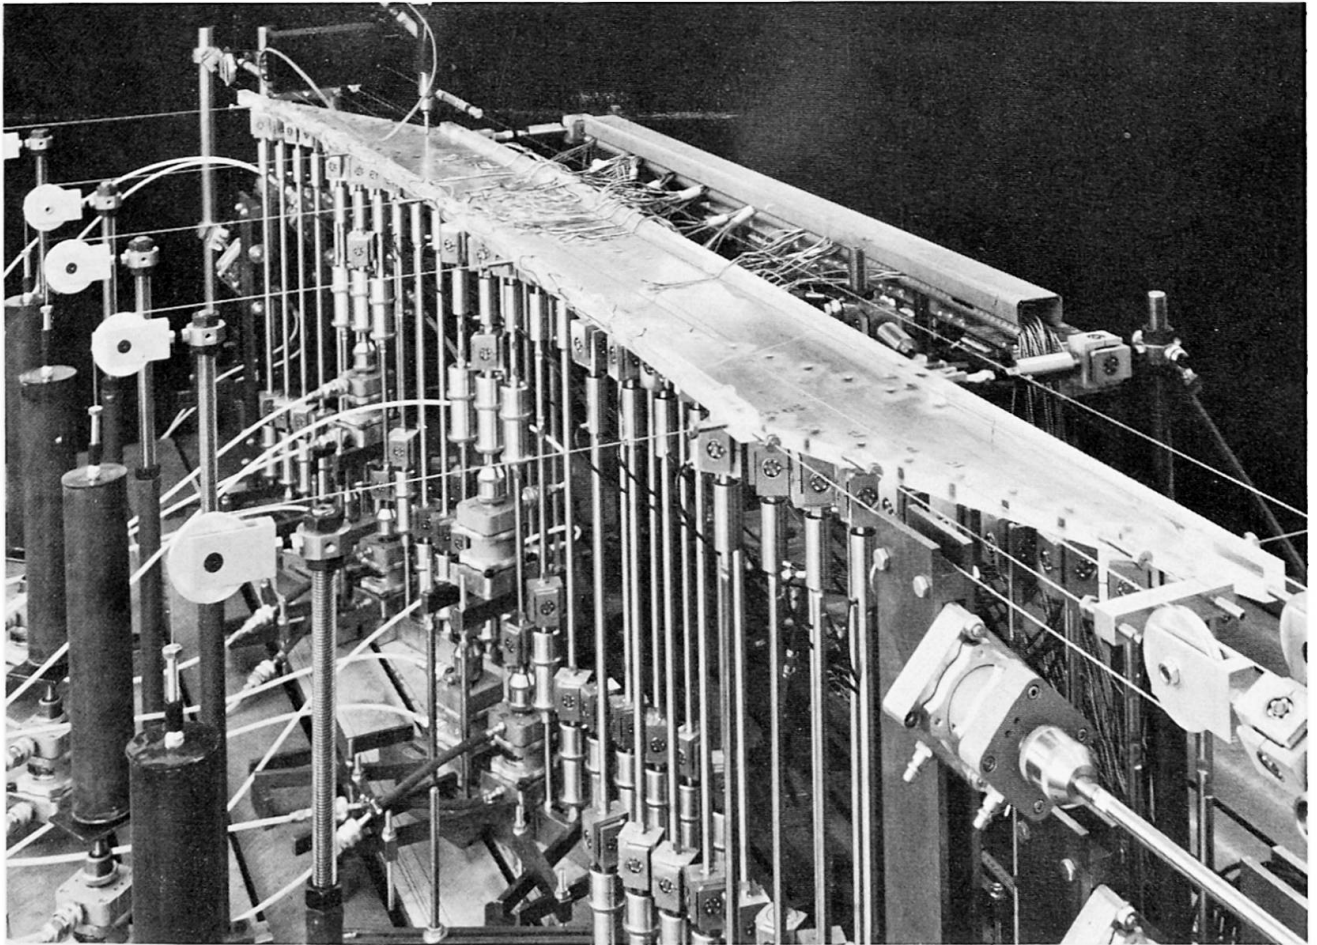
Versuchsaufbau der Brücke Killwangen.
